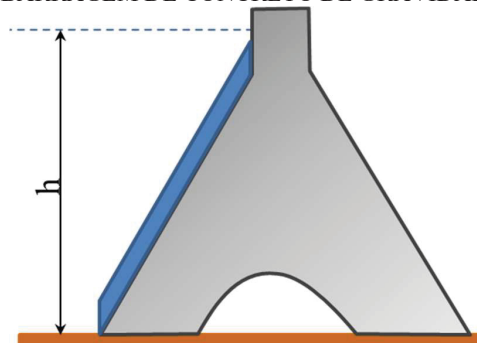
BARRAGEM DE CONCRETO DE GRAVIDADE
